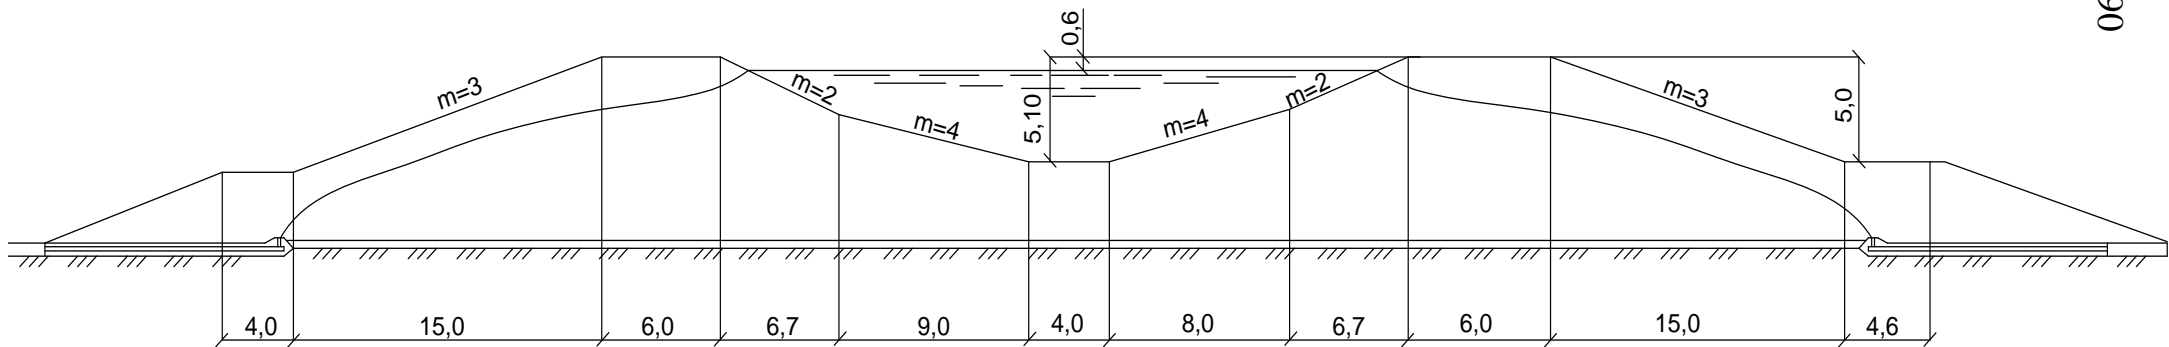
Поперечные сечения ПМК при высоте насыпи дамб от 6 до 8 метров
